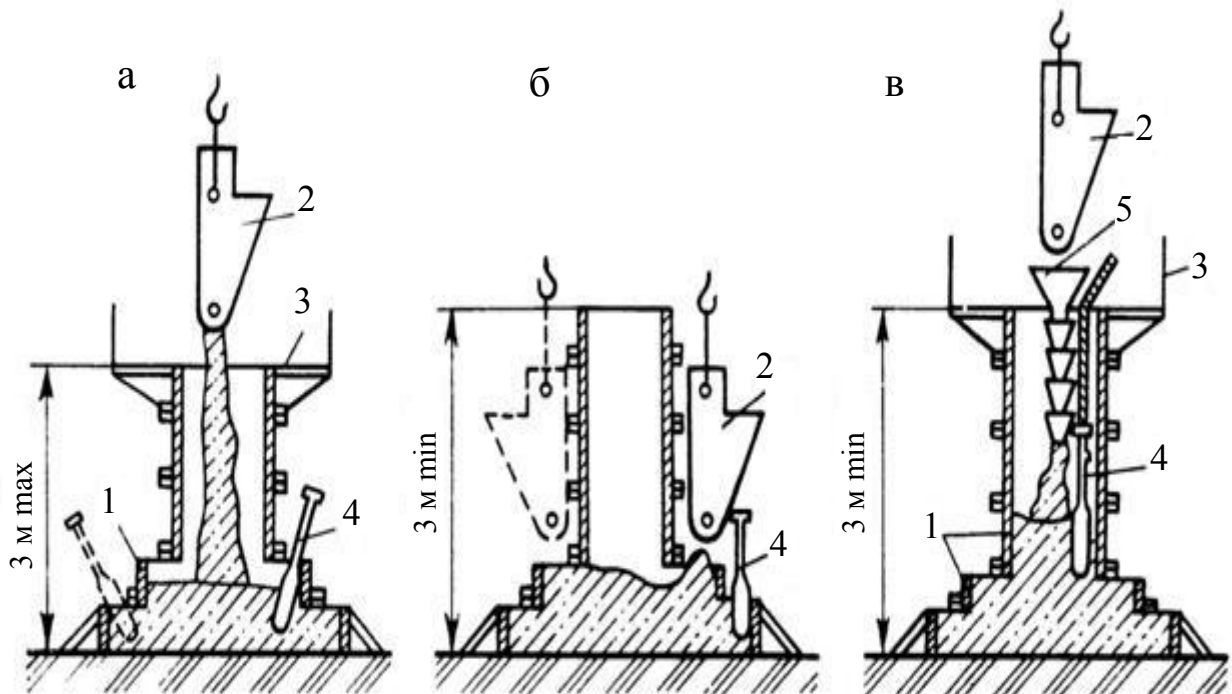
Бетонування східчастих фундаментів: а – висотою до 3 м; б, в – висотою 3 м; 1 – опалубка східця; 2 – баддя; 3 – настил; 4 – внутрішній вібратор; 5 – приймальна воронка
